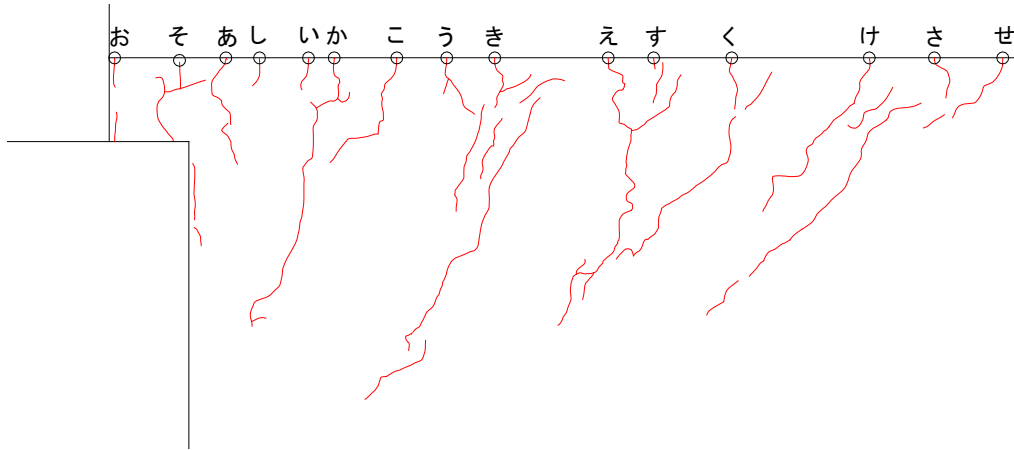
基礎梁ひび割れ幅測定位置(試験体 A-4 負荷荷)
